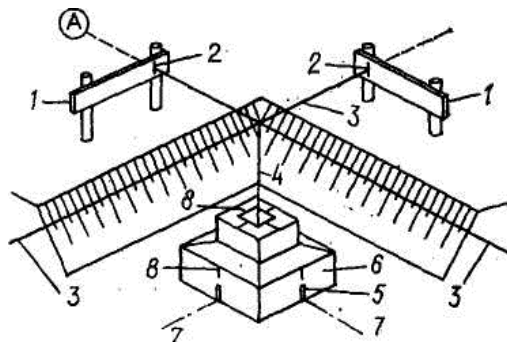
Розмічування осей фундаменту під колону:
